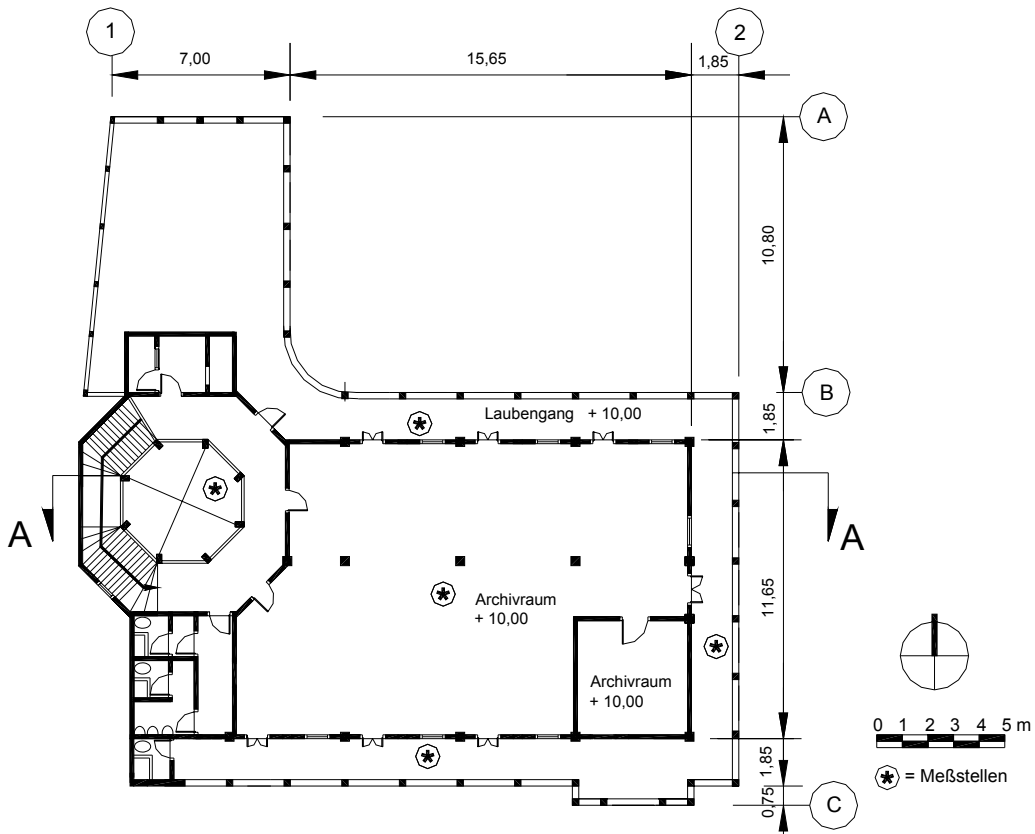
Grundriss 2. Obergeschoss von Gebäude C5
